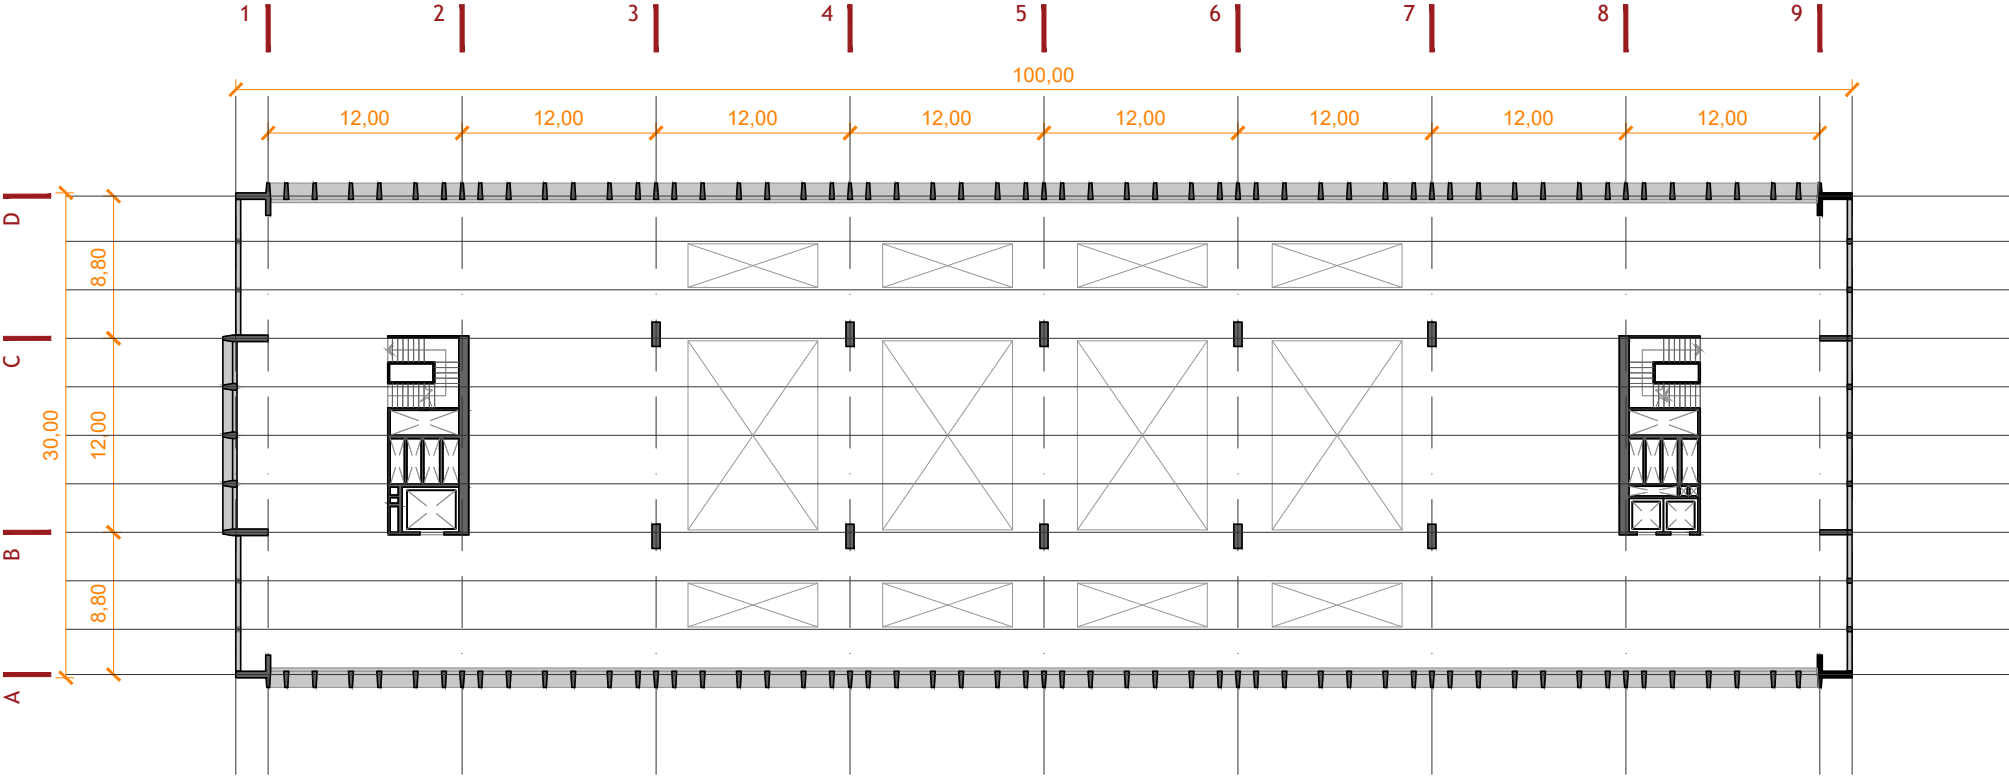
Planta proyecto, se aprecia las perforaciones funcionales, hoy estas se encuentran cubiertas Fuente: Elaboración propia
